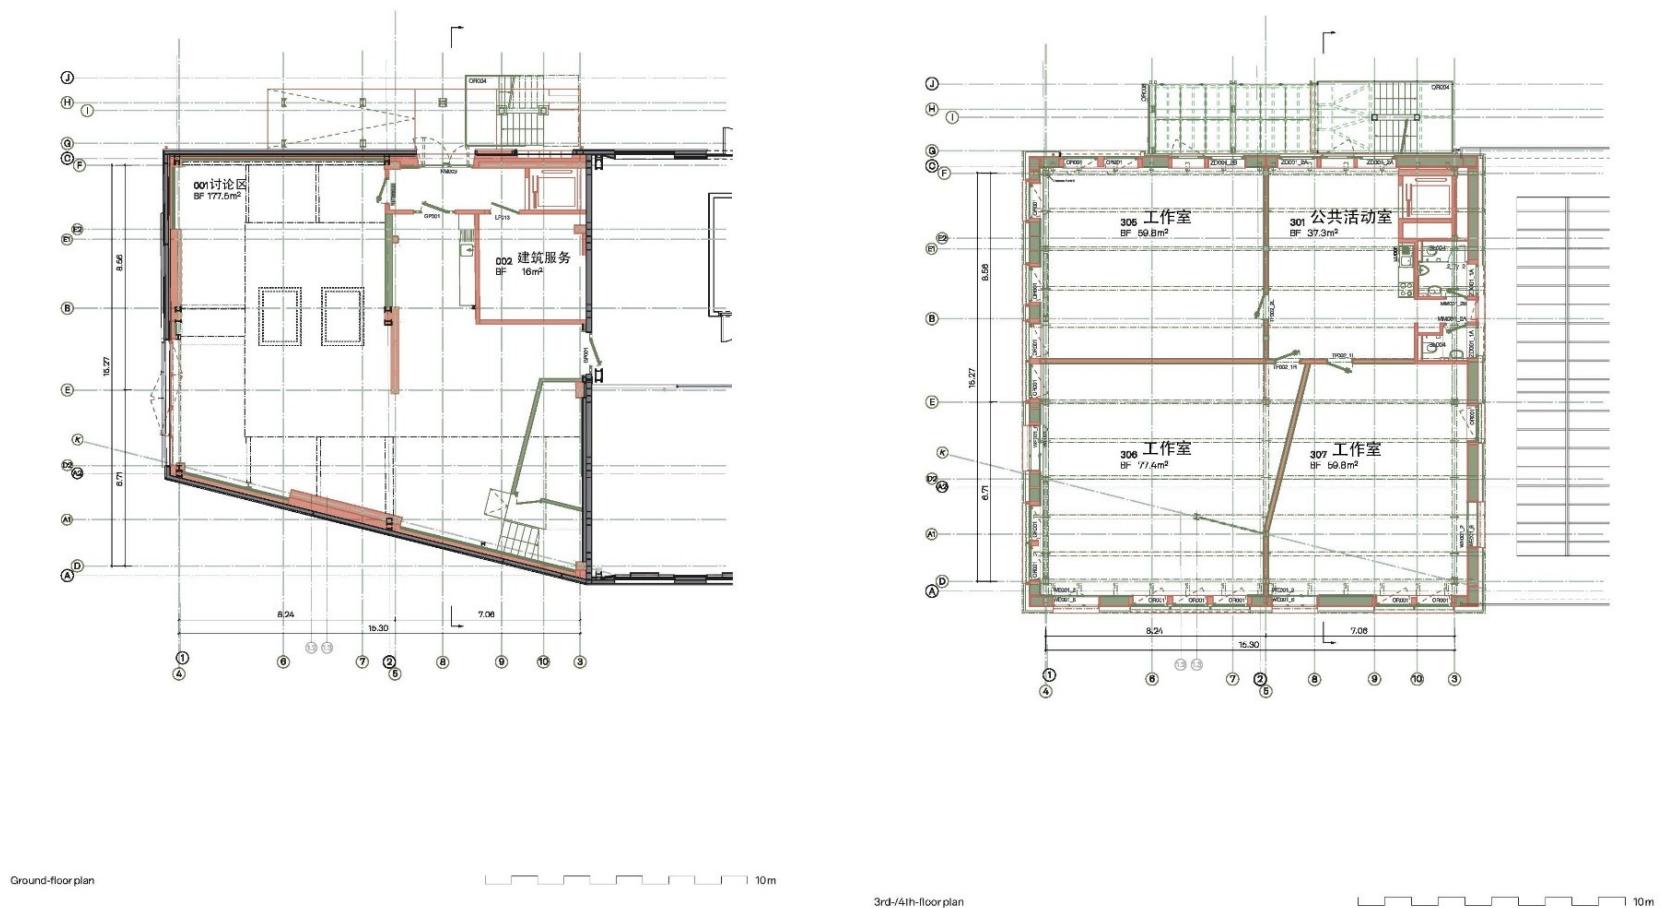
地面层, 三层和四层平面图 ©Baubüro in situ
